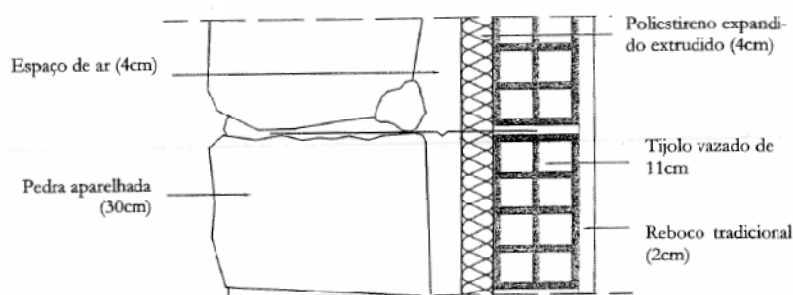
Parede dupla com pano exterior em alvenaria de pedra e pano interior em alvenaria de tijolo vazado [14]
